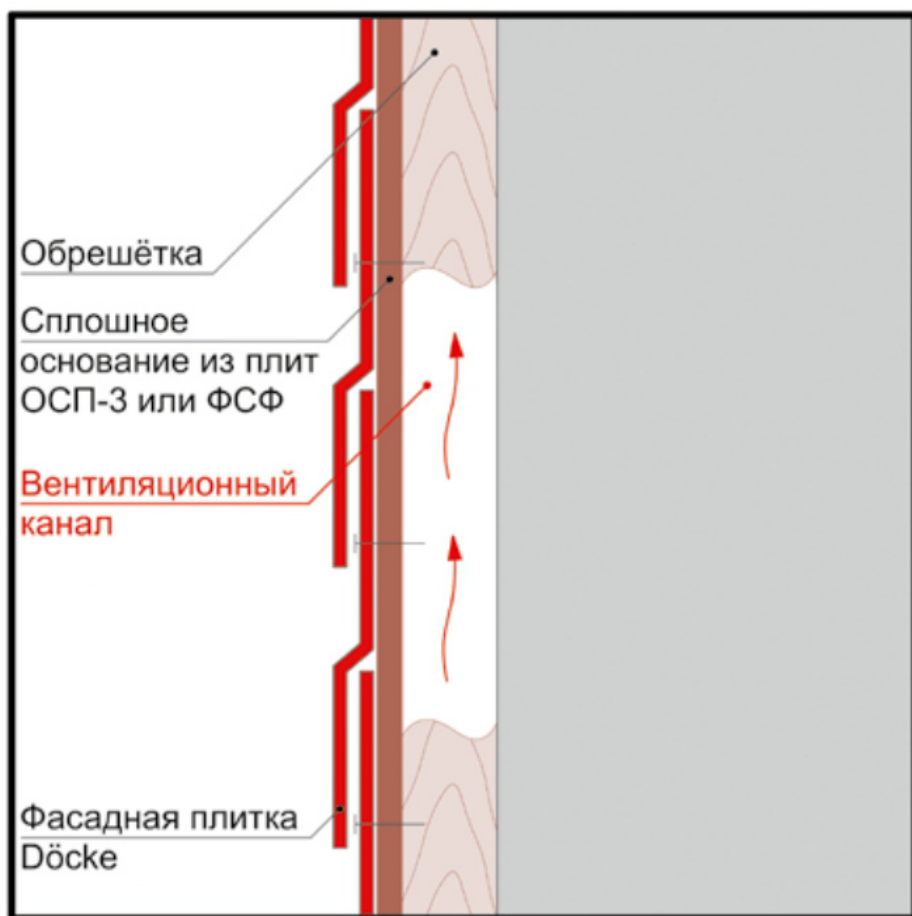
Схема вентилируемого фасада на примере фасадной плитки Döcke.
